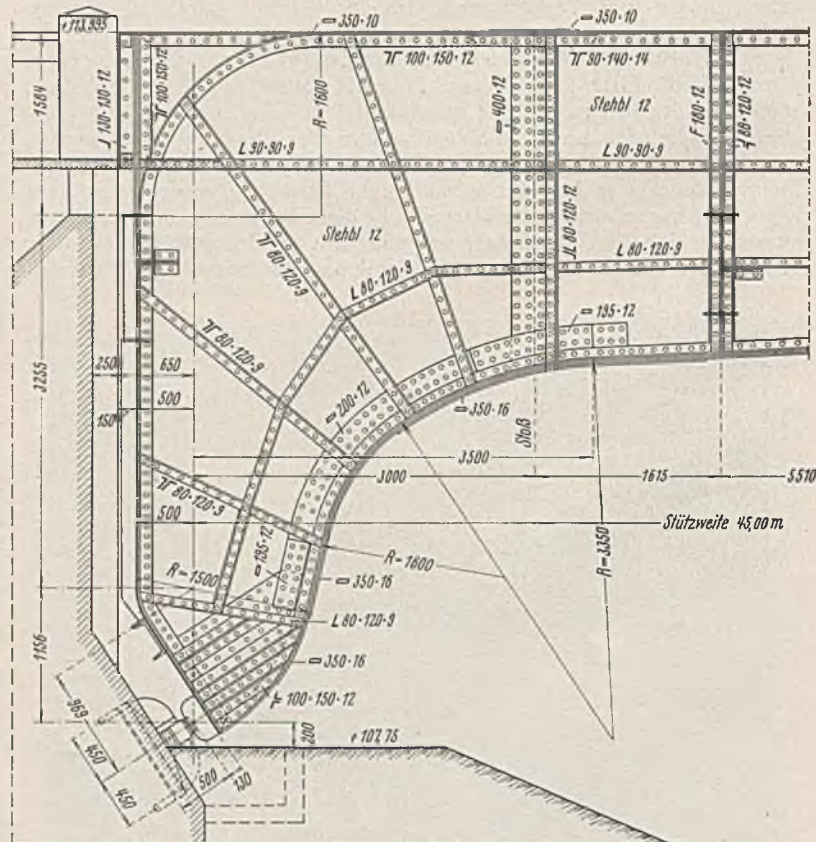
Militzer Straßenbrücke, Rahmenecke und Lager.
